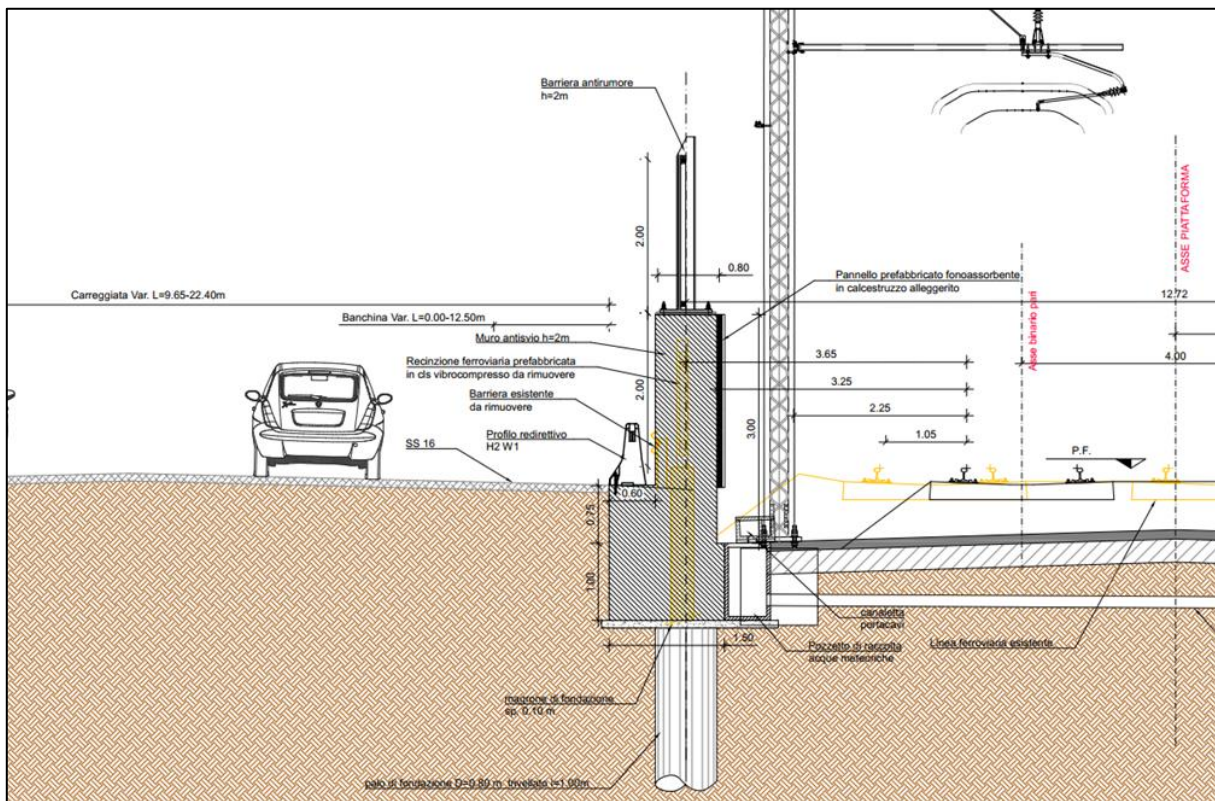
Sezione tipo barriera antirumore su tratto nord fase 1
